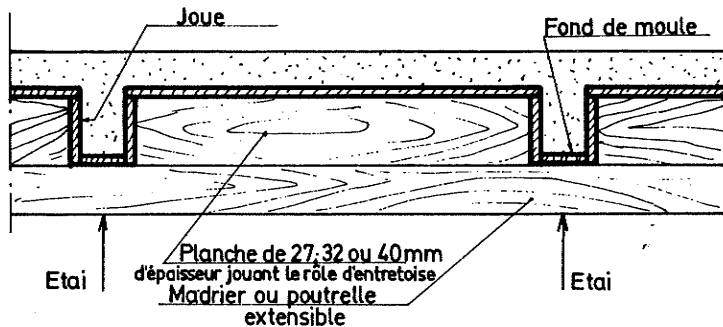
Coffrage élémentaire avec bacs coffrants en bois.
